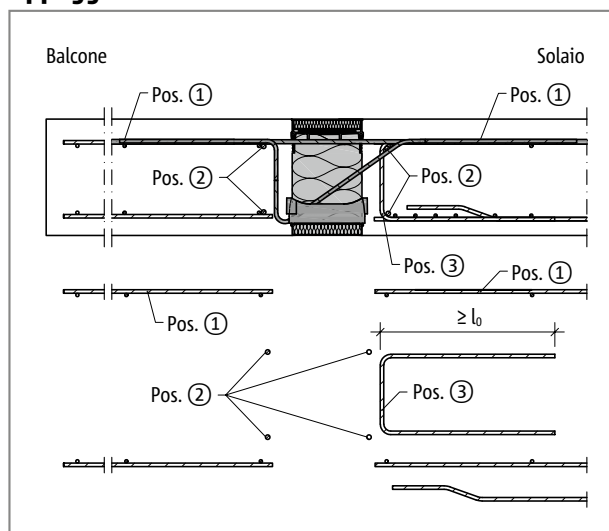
Schöck Isokorb® XT tipo KL: armatura in opera con appoggio indiretto
